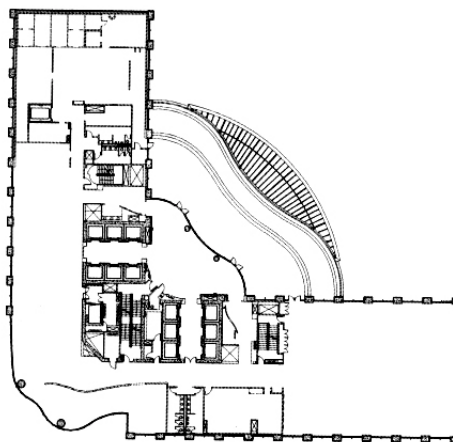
Planta do 1º pavimento (Fonte: Revista Projeto 269, 2002)
